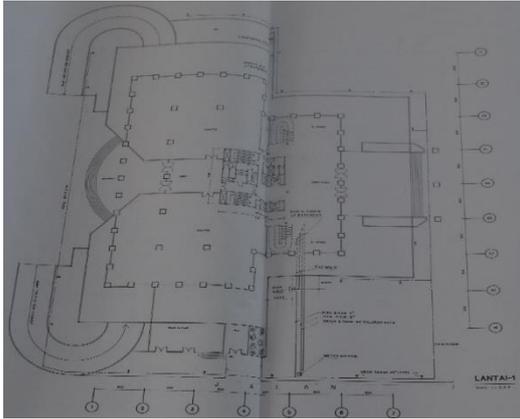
(a) Denah asli gedung tampak timur dan bentuk nyata saat ini (Sumber : Denah dari KBSRT STT-PLN)
